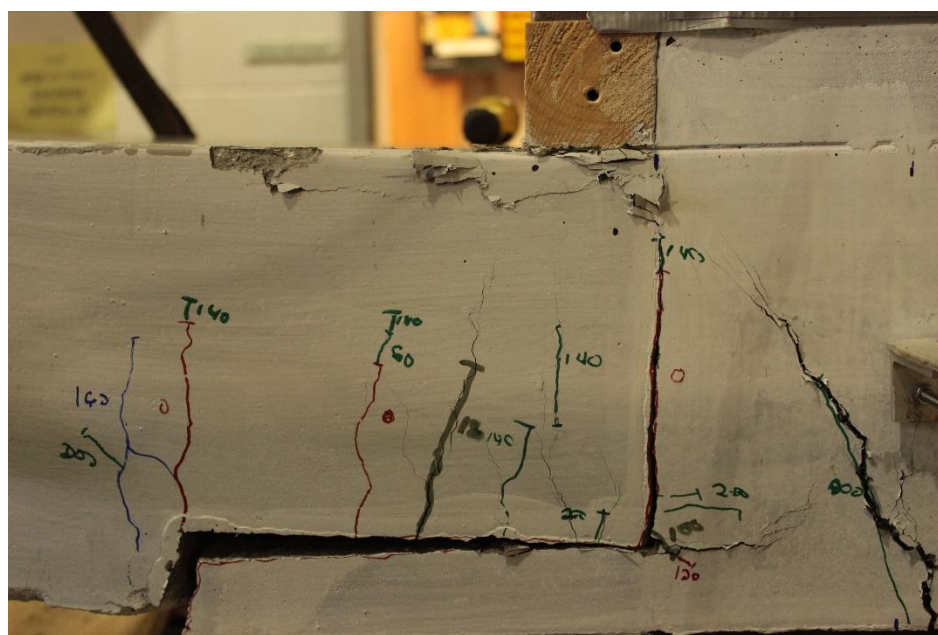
Fissuration à l'est du spécimen avec de grandes ailes (S3-GA)
